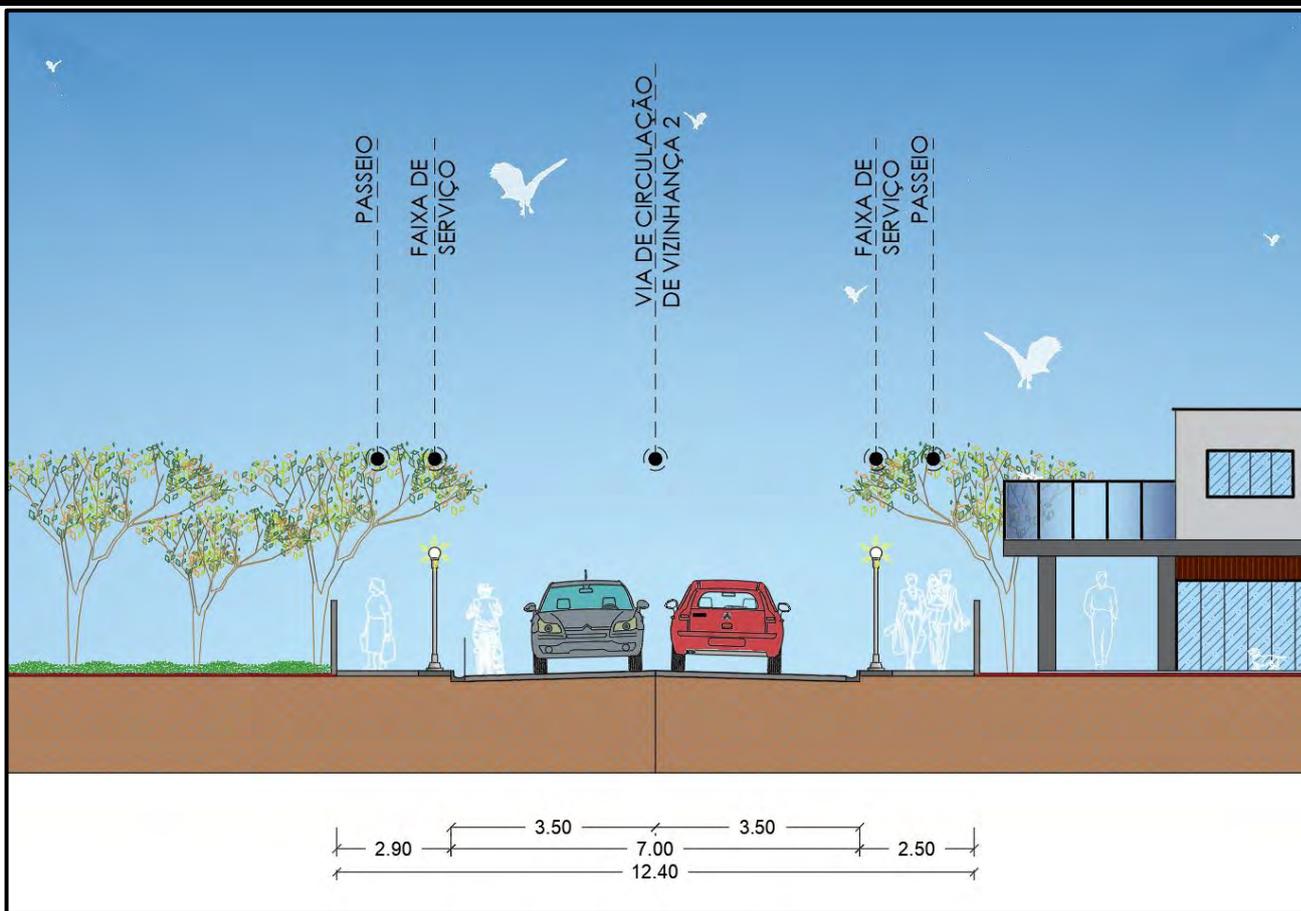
Perfil 2 – Via de Circulação de Vizinhança 02 (Zona 30) – Via Existente (Cond. Belvedere Green)
